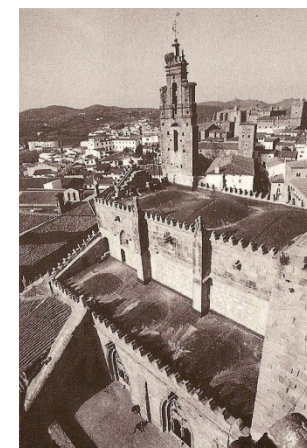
Estado de las cubiertas de la Catedral Antigua tras la intervención de 1981.
